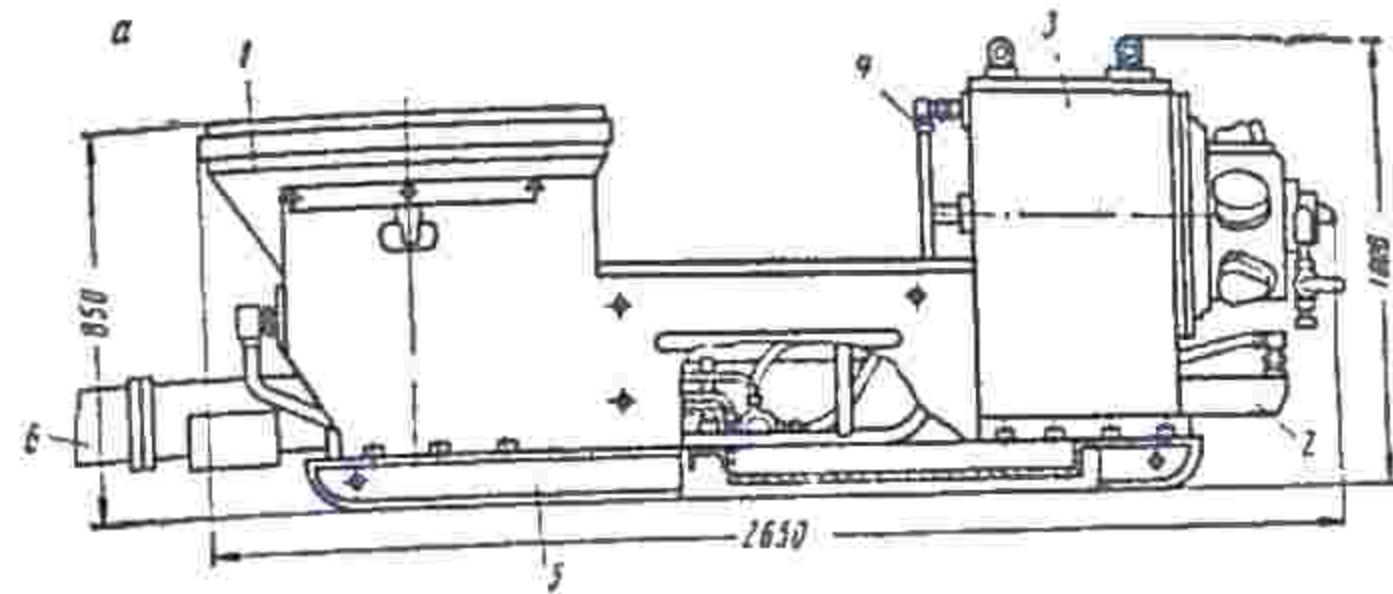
Укладчик бетонной смеси УБМЗ-5
